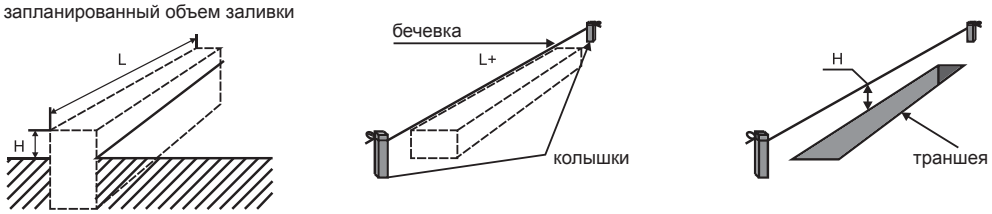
Натягивание бечевки по уровню верхнего края будущей опалубки
